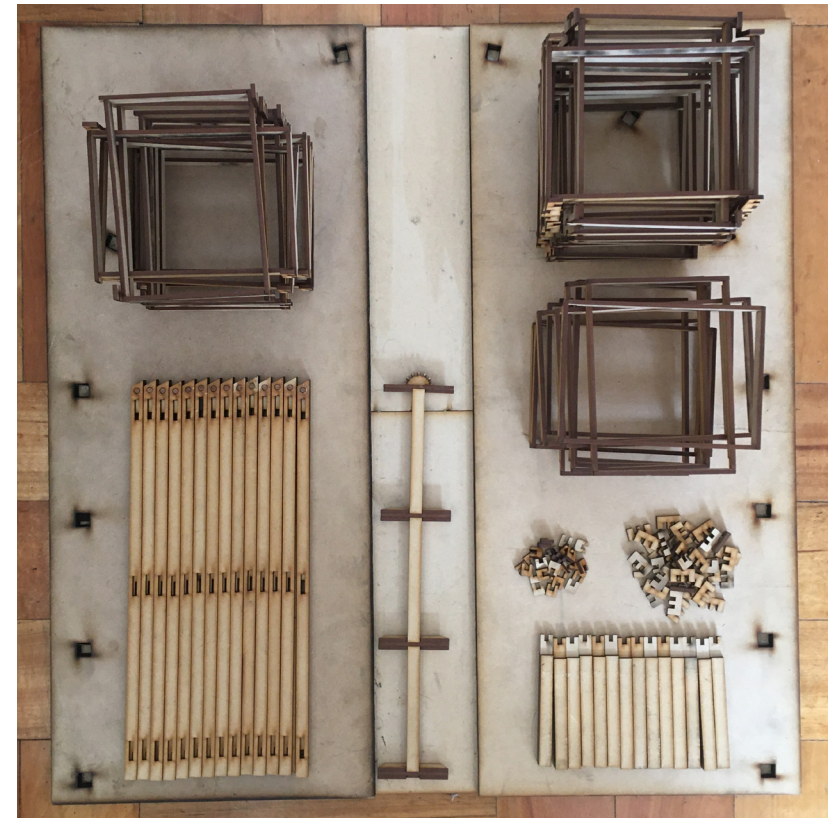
Fabricación a escala de piezas prefabricadas, maqueta prototipo. elaboración propia
